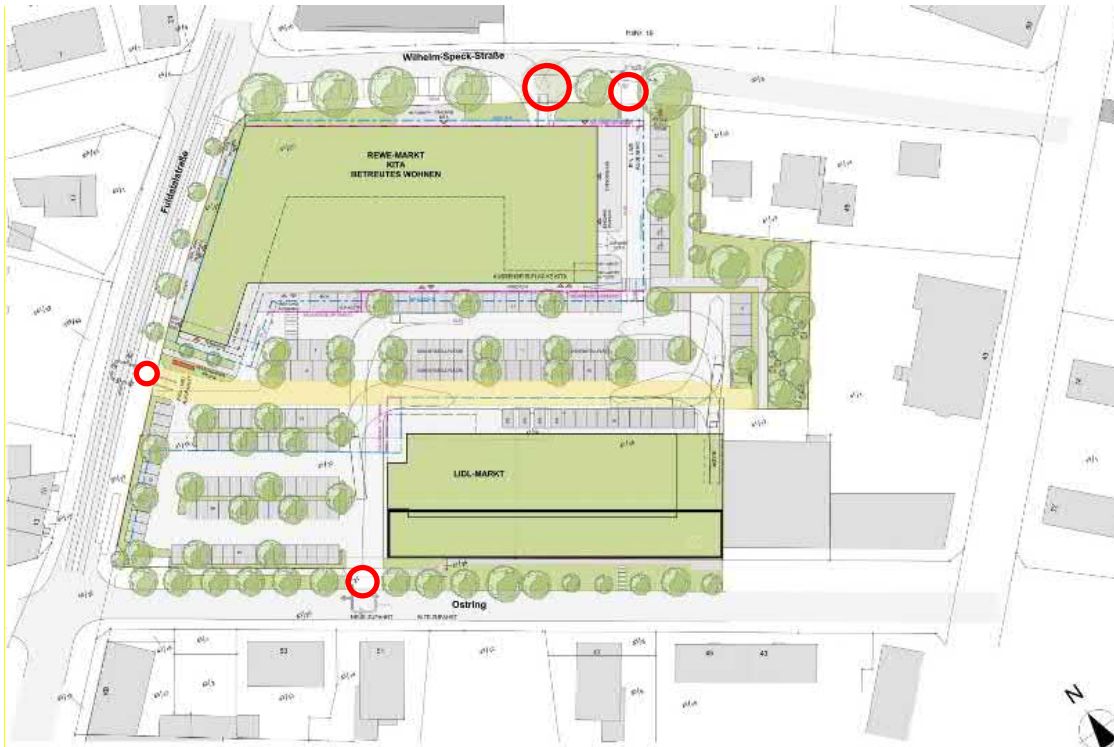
Übersichtsplan, zu fallende Bäume rot markiert, erstellt: Büro Stiebing Architektur
